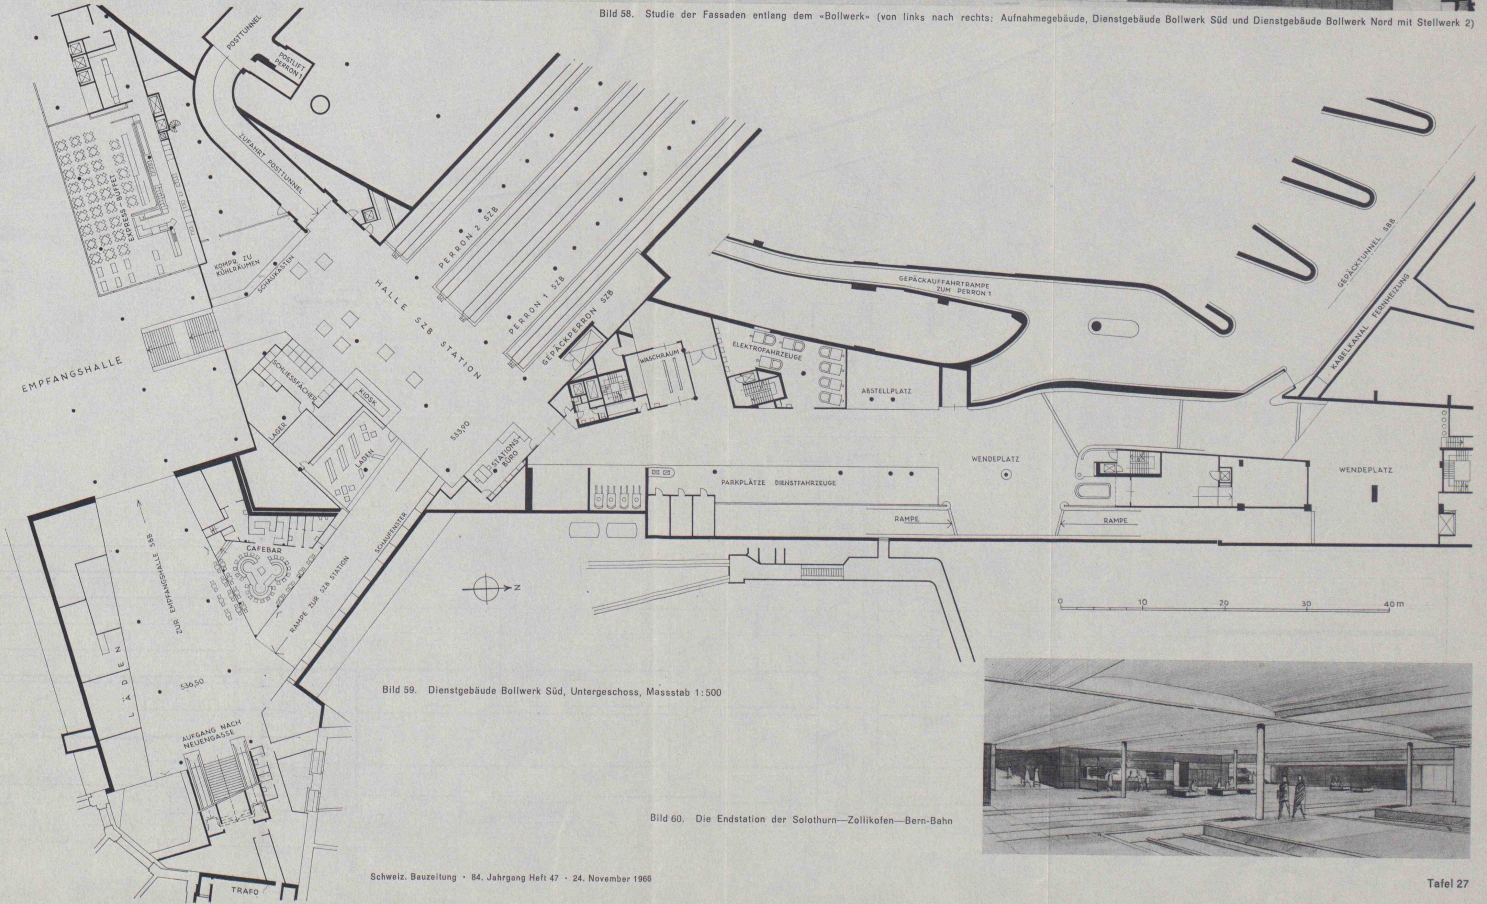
Dienstgebäude Bollwerk Süd, Untergeschoss, Massstab 1:500
